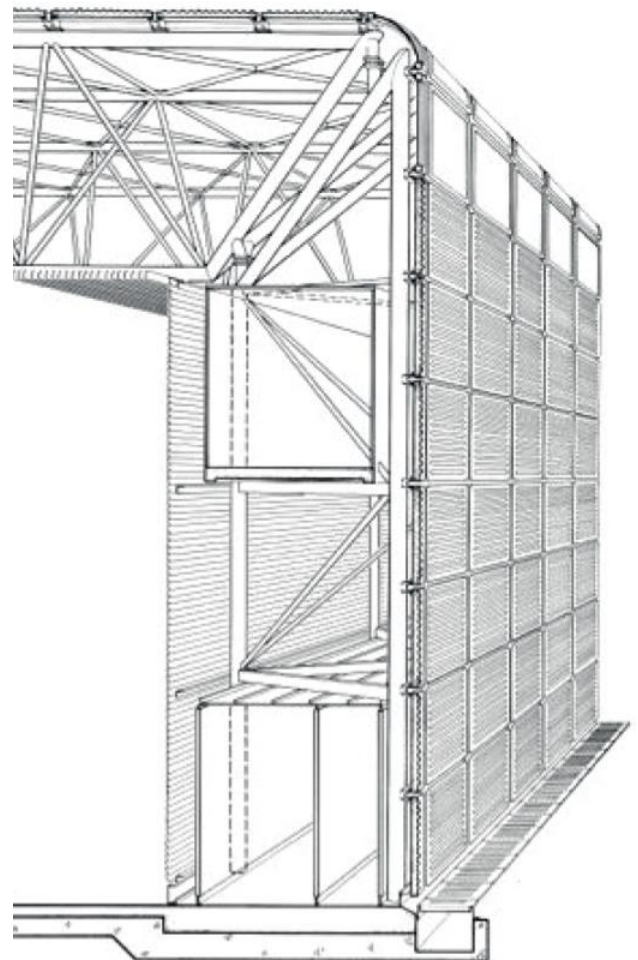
SECCIÓN FUGADA DEL SISTEMA ESTRUCTURAL
